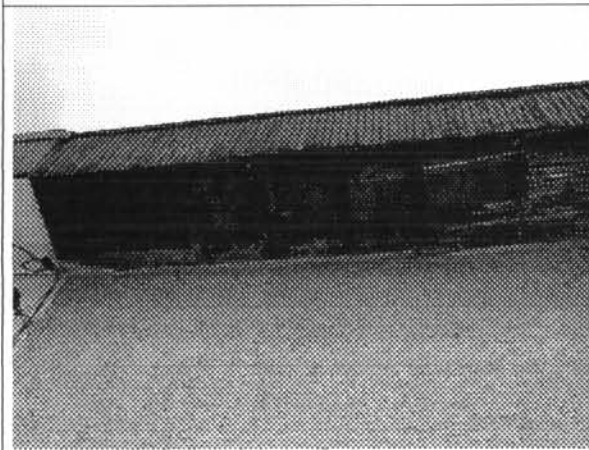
Cubierta en madera (zona de voladizo – evidencia de incendio)
